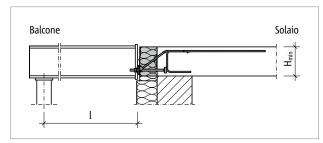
Schöck Isokorb® XT tipo SQP: schema statico
